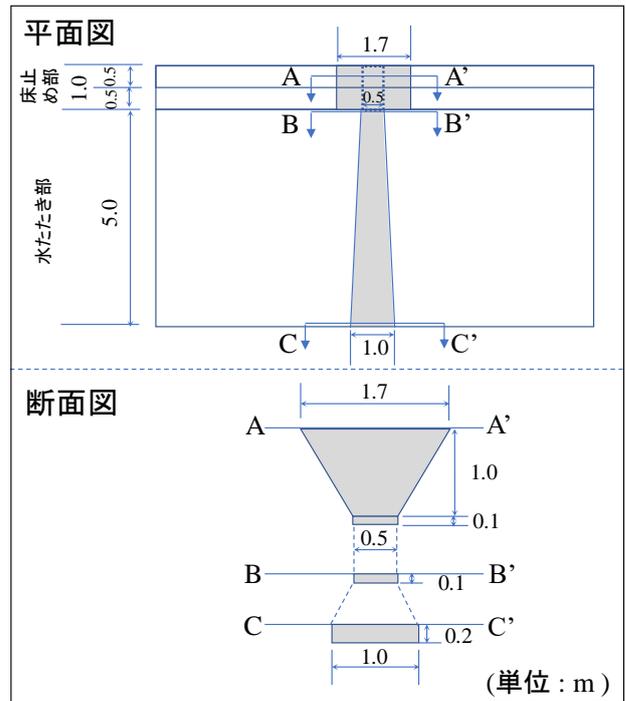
切欠き魚道 平面図(上図)・断面図(下図)
